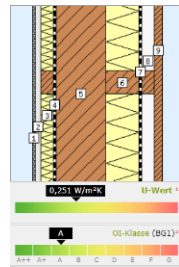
Erste Variante der Bauteilaufbau, Außenwand mit der Steinwolle
